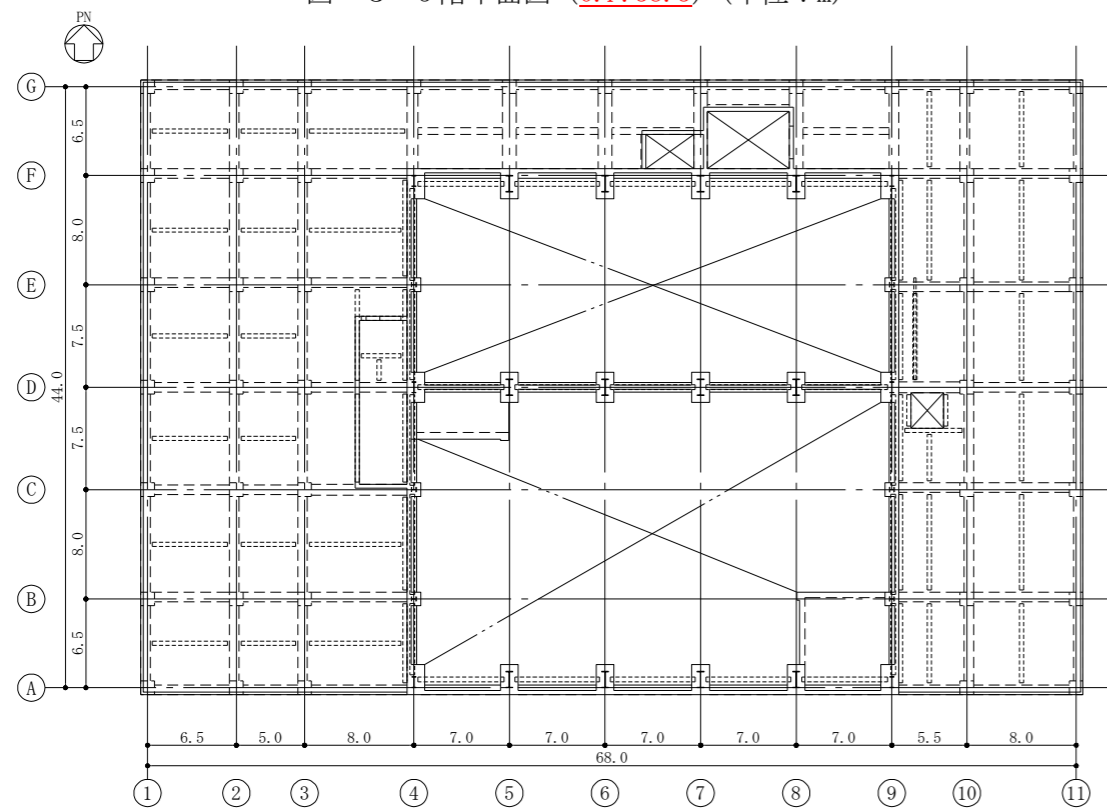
屋根平面図 (その1) (O.P.44.3) (単位:m)
